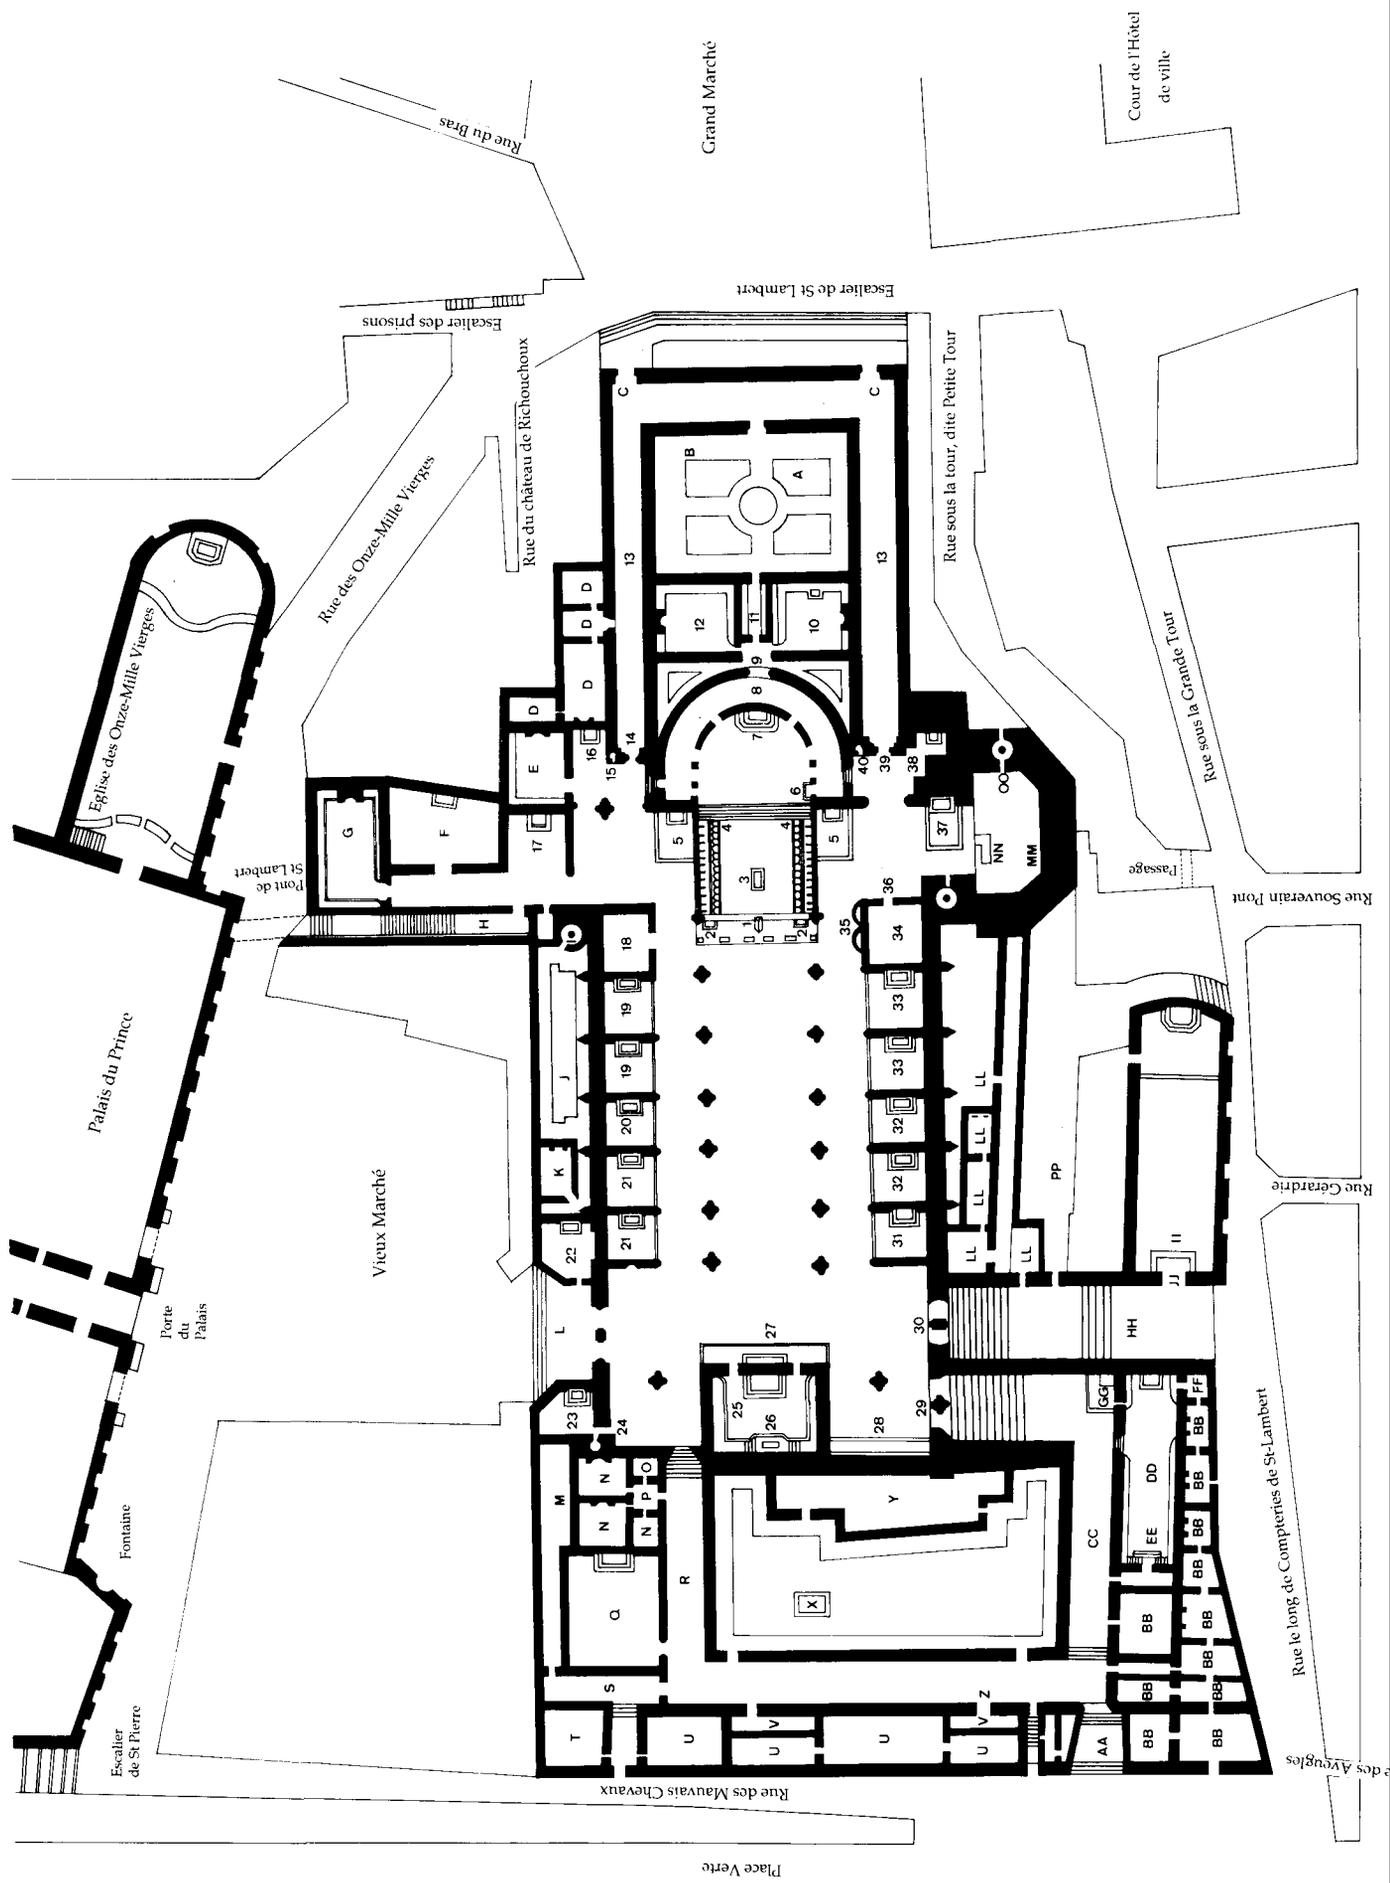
Copie du plan de CARRONT (XVIII^e siècle).
